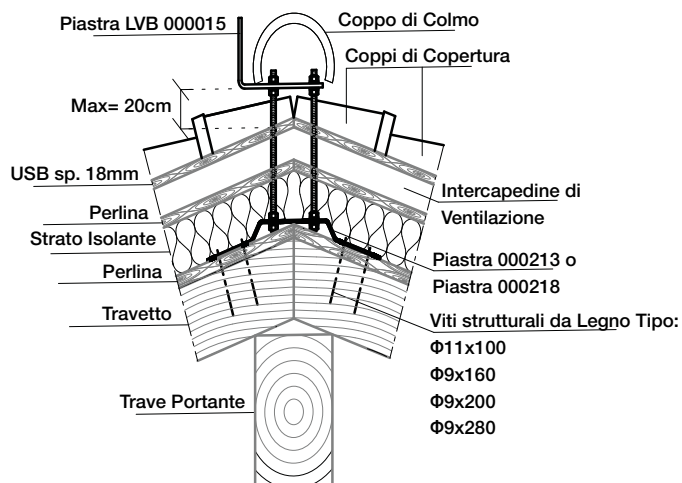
Sezione del dispositivo LVB fissato con piastra di ripartizione carichi da colmo su struttura di supporto in legno.
